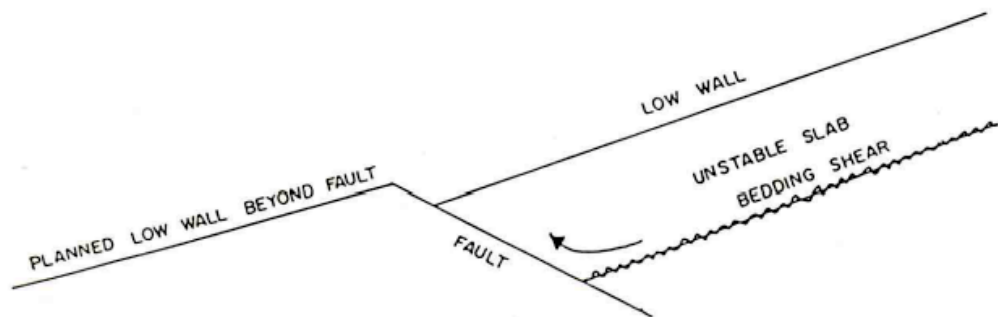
Mode 1 – Plane failure or slab sliding
